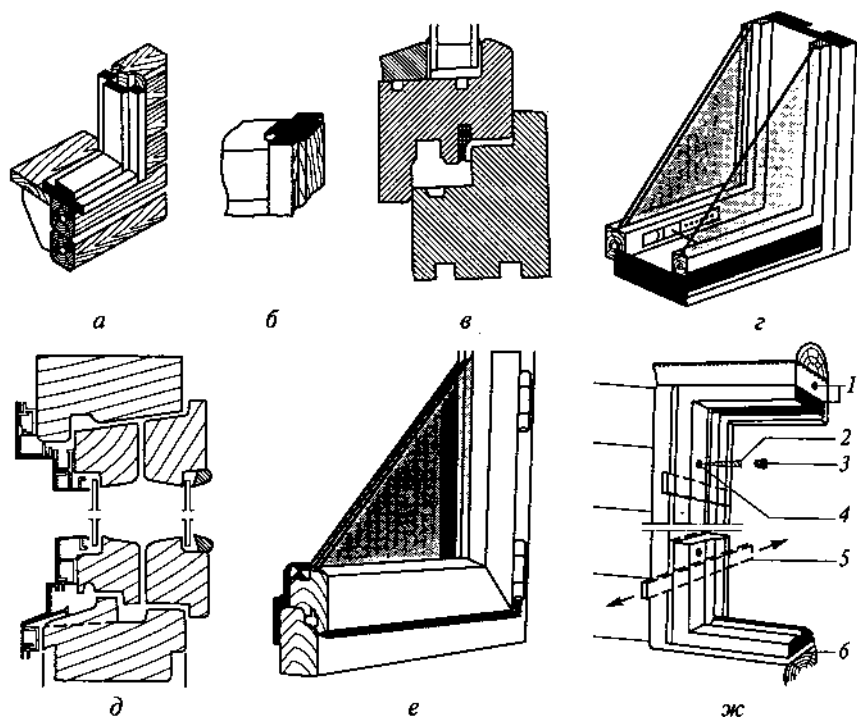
Конструкции деревянных и деревометаллических оконных систем:
